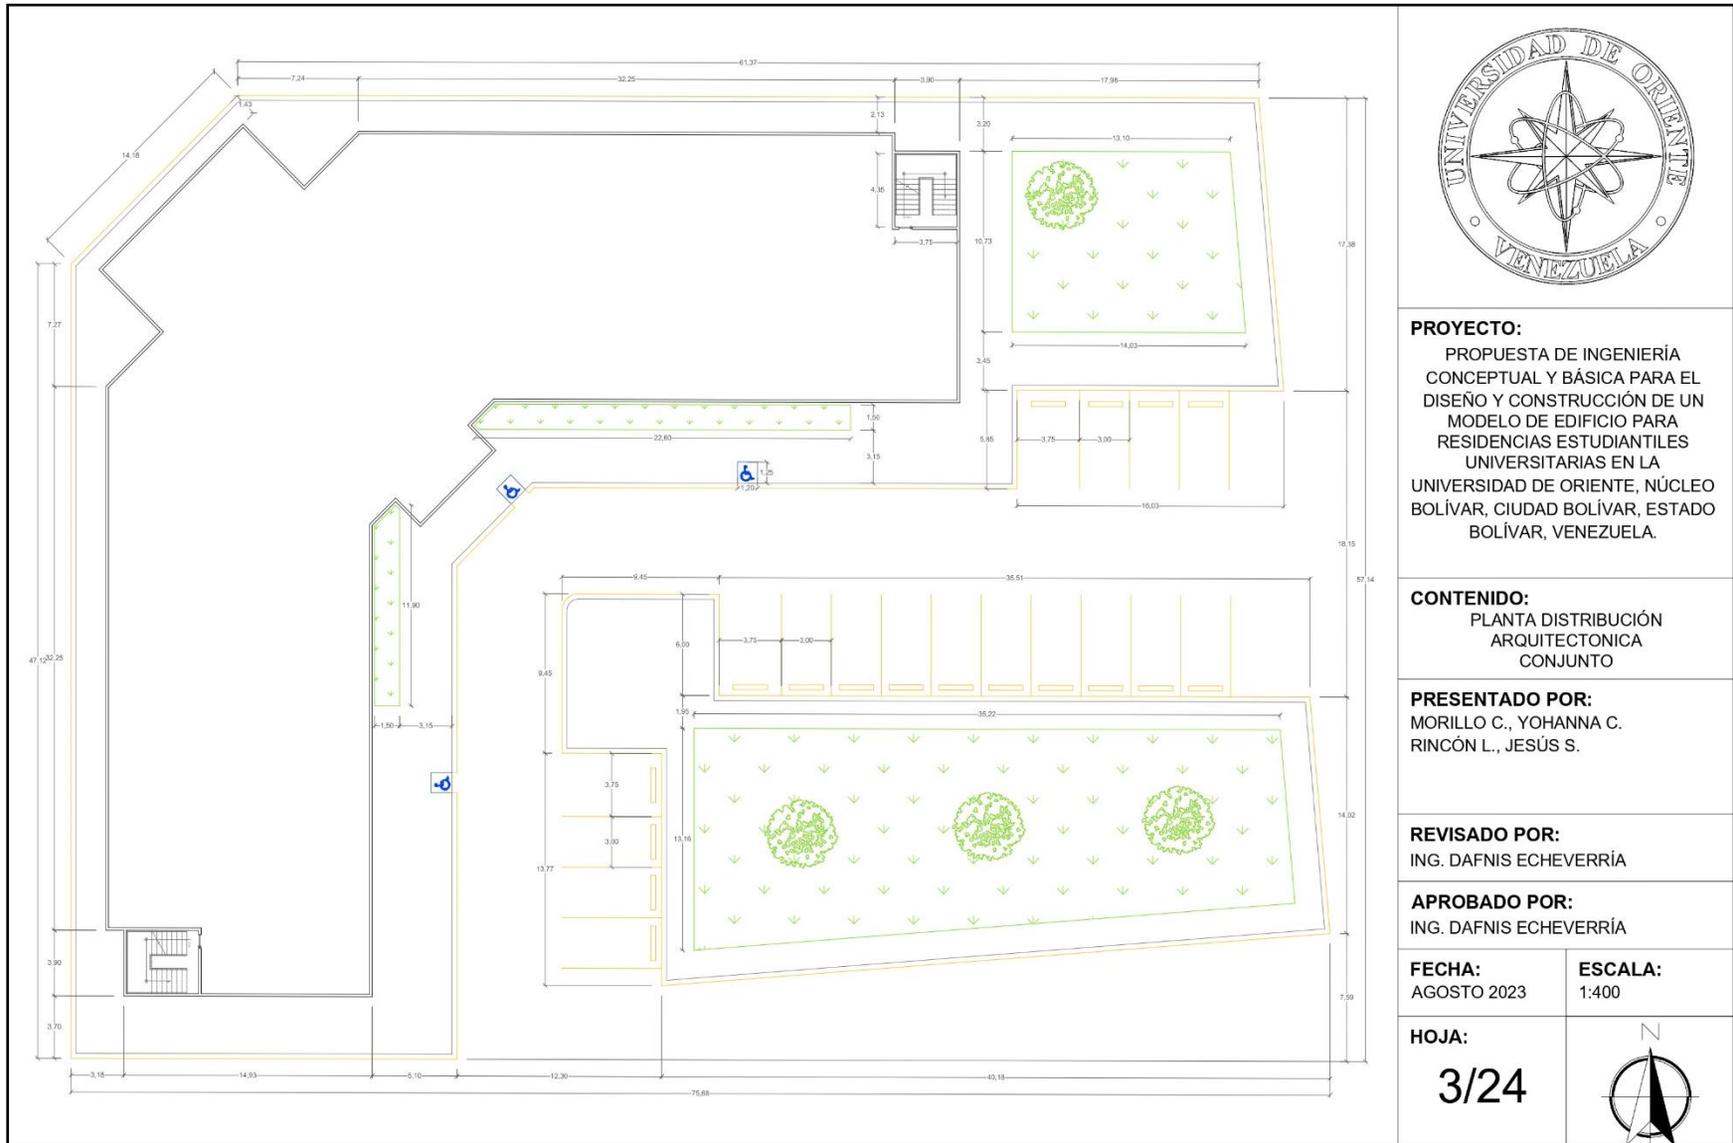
Plano de Planta distribución arquitectónica. Conjunto.
